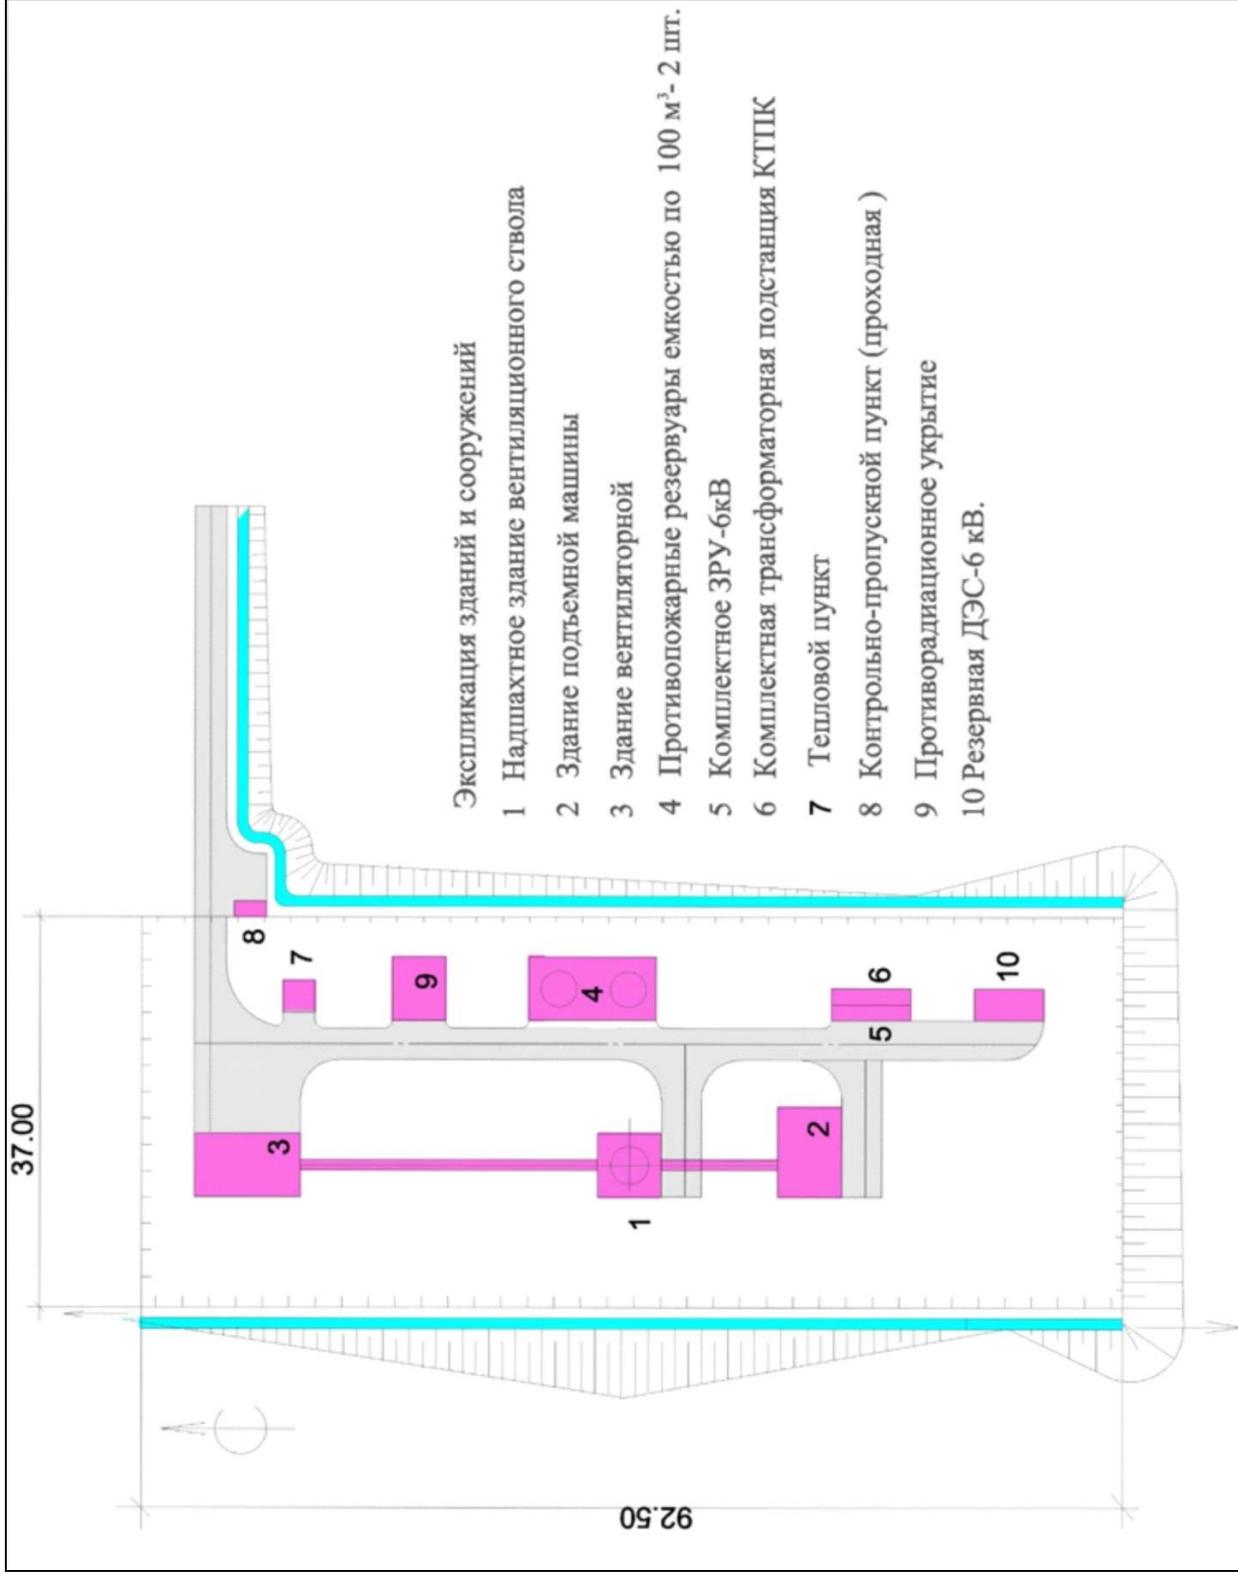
Схема организации и экспликация зданий площадки вентиляционного ствола
